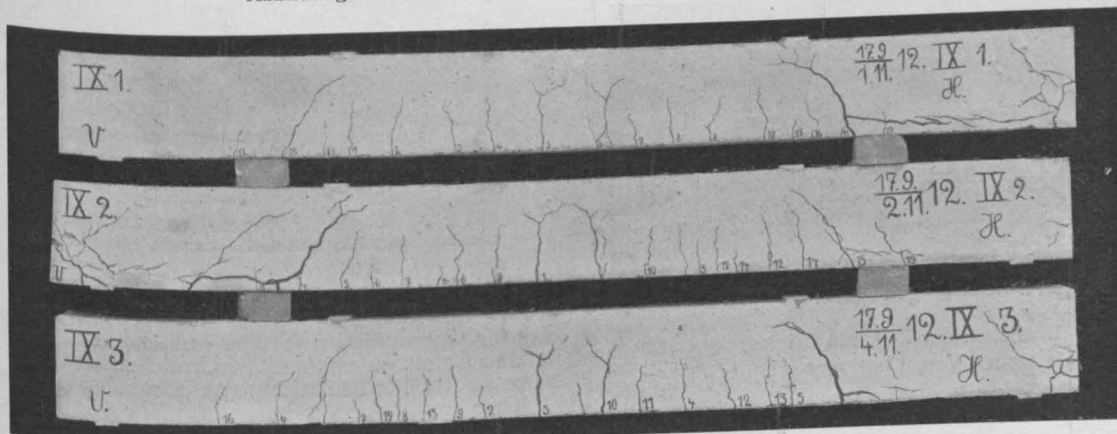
Versuchsbalken mit Gitterträgern aus Rundeisen.
